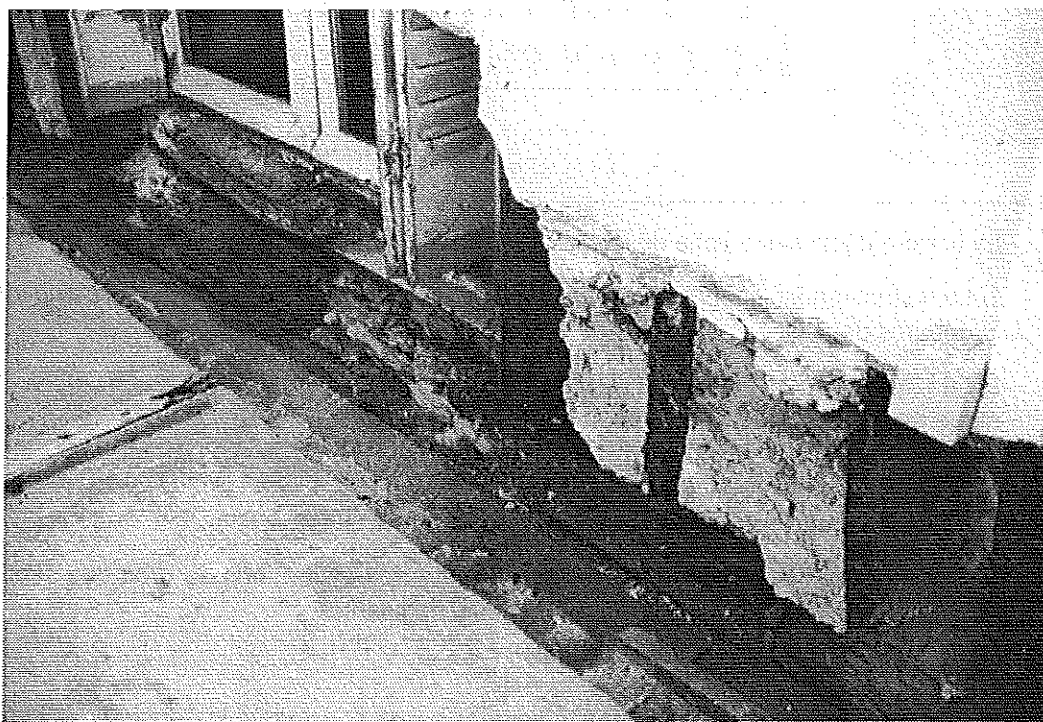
Dégagement de la base de façade de l'étage en retrait :
